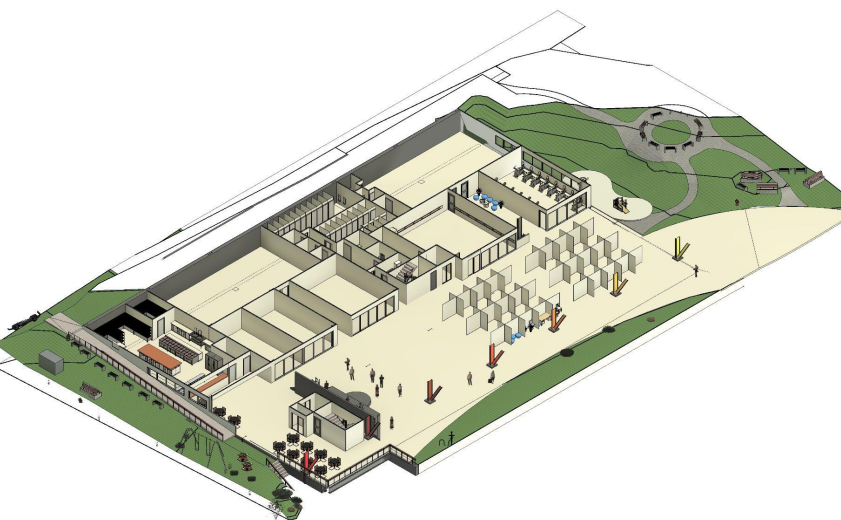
Vista 3D, planta nivel 1 Fuente propia.
